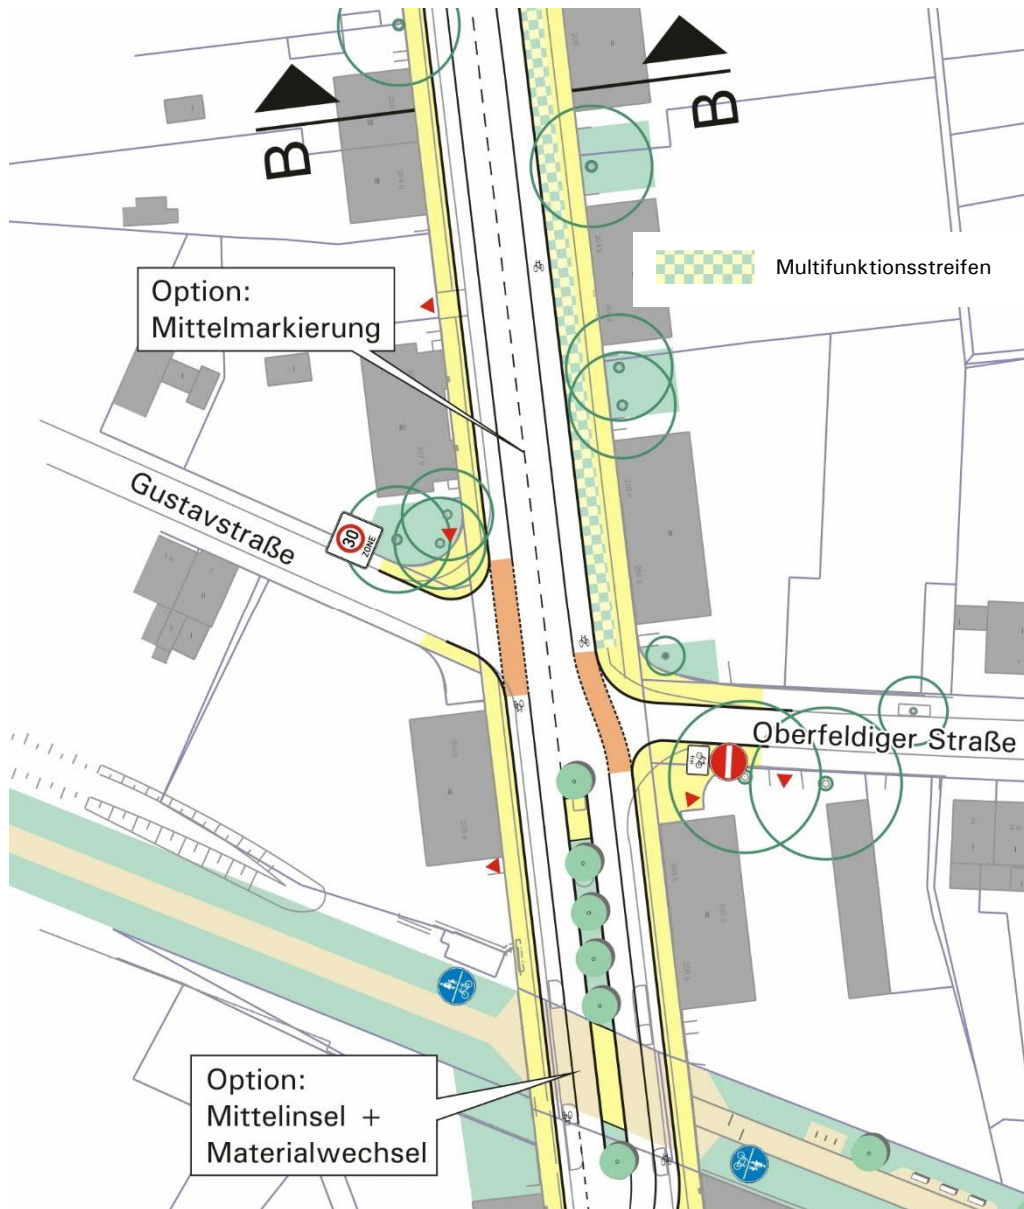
Lageplanausschnitt Gartenstadt – Variante 2 Veloroute
